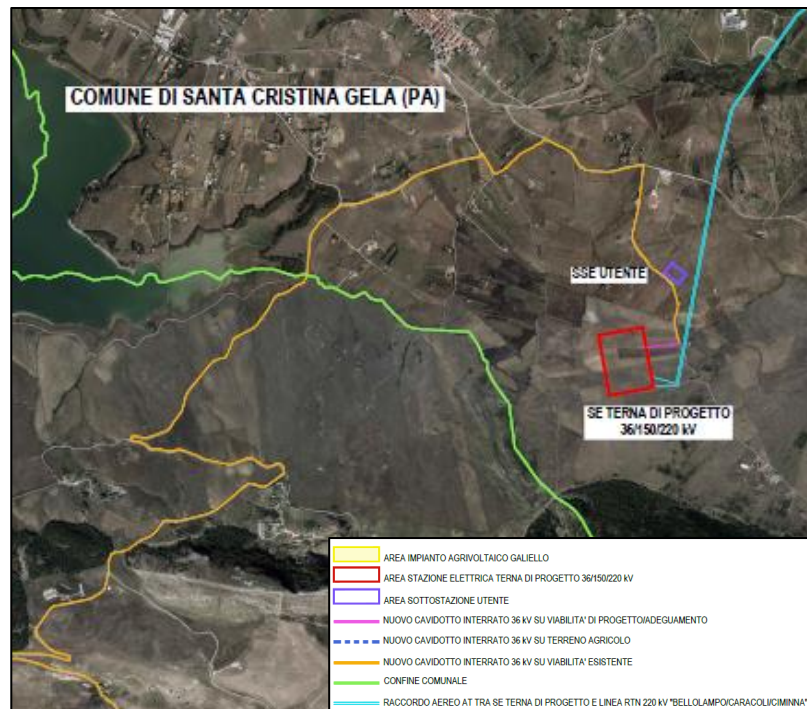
Inquadramento opere di progetto (aree stazioni) su Ortofoto
